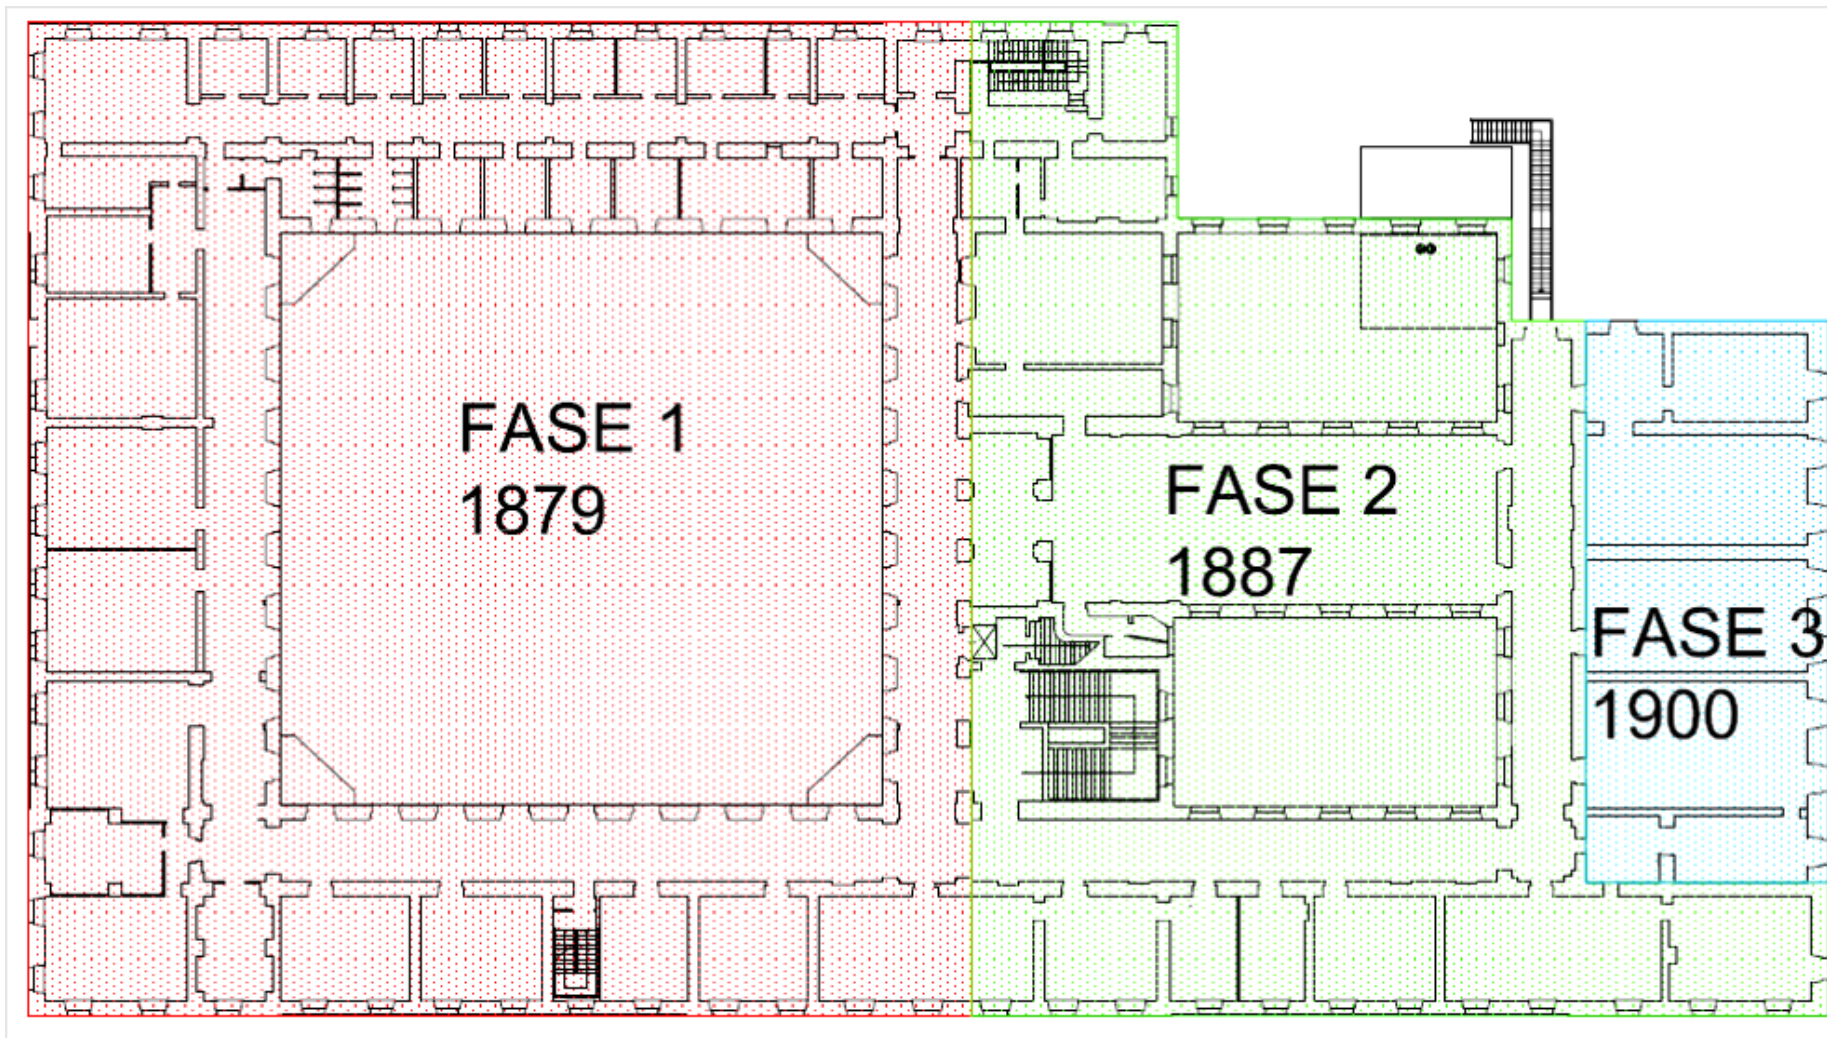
Convitto Nazionale "M. Pagano": Pianta delle fasi costruttive
